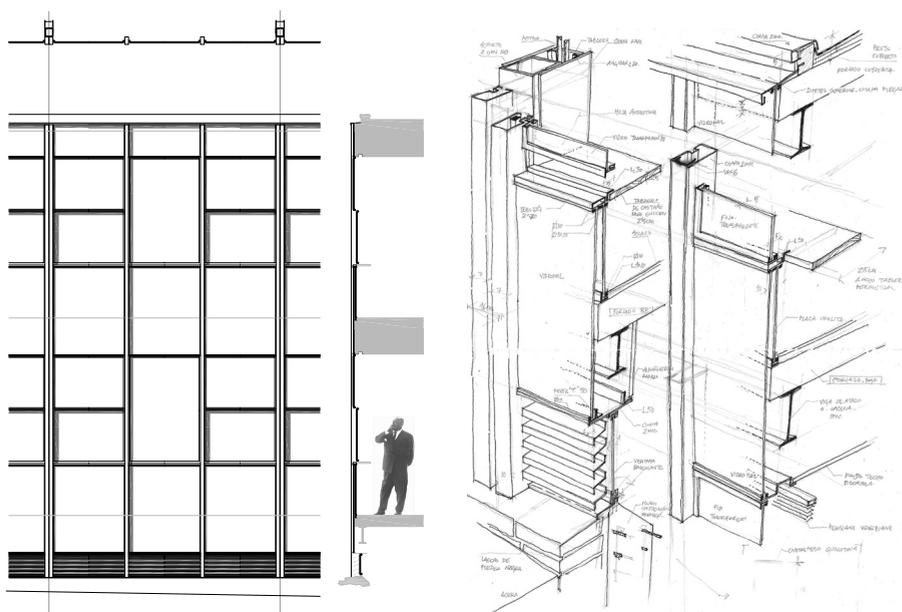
Levantamiento detalle constructivo de fachada del volumen A. Del Autor
